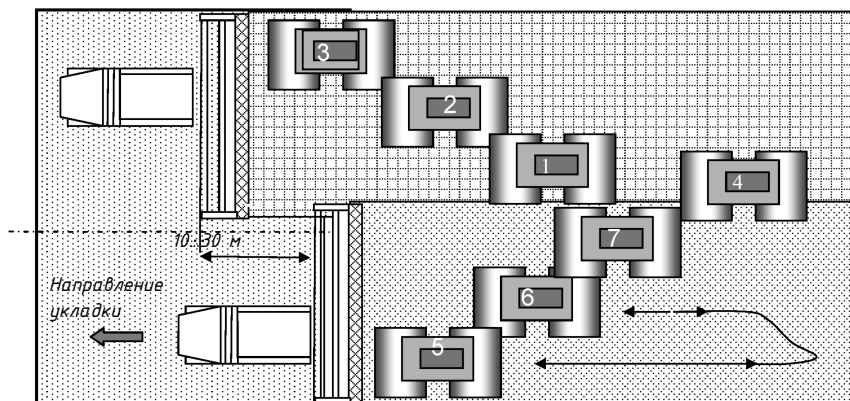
Технологическая схема укладки асфальтобетонного слоя двумя укладчиками
